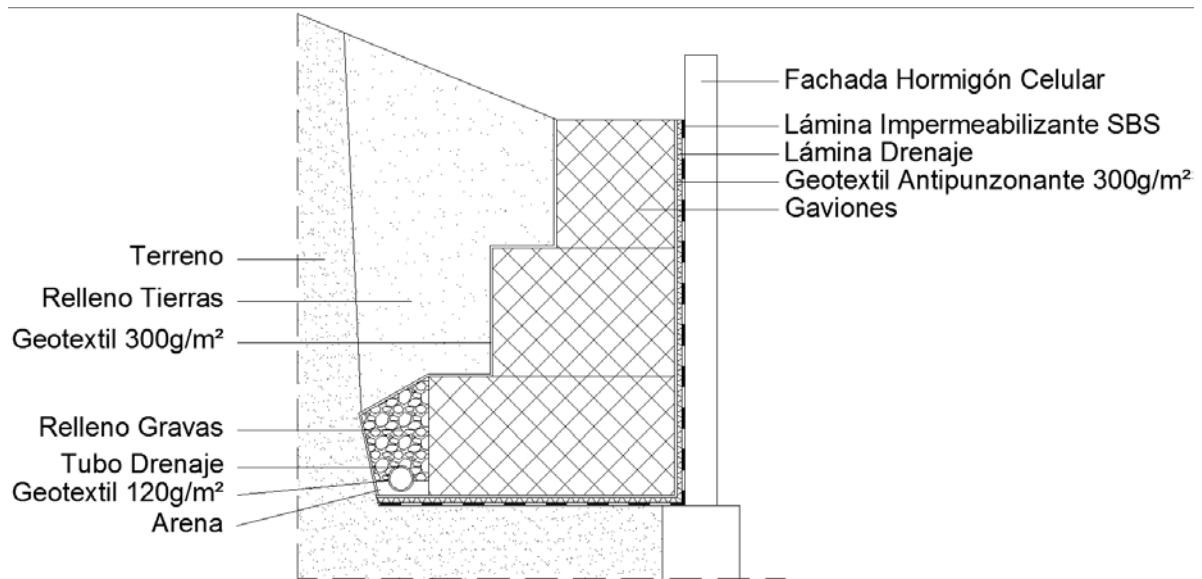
Detalle Muro Gaviones Fachada Norte. 2017. Propio
